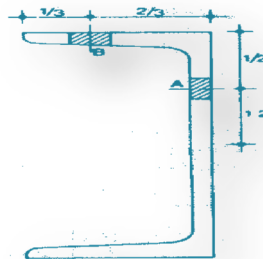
Perfil UPN. Fuente Diseño de Estructuras de Acero de McCormac
